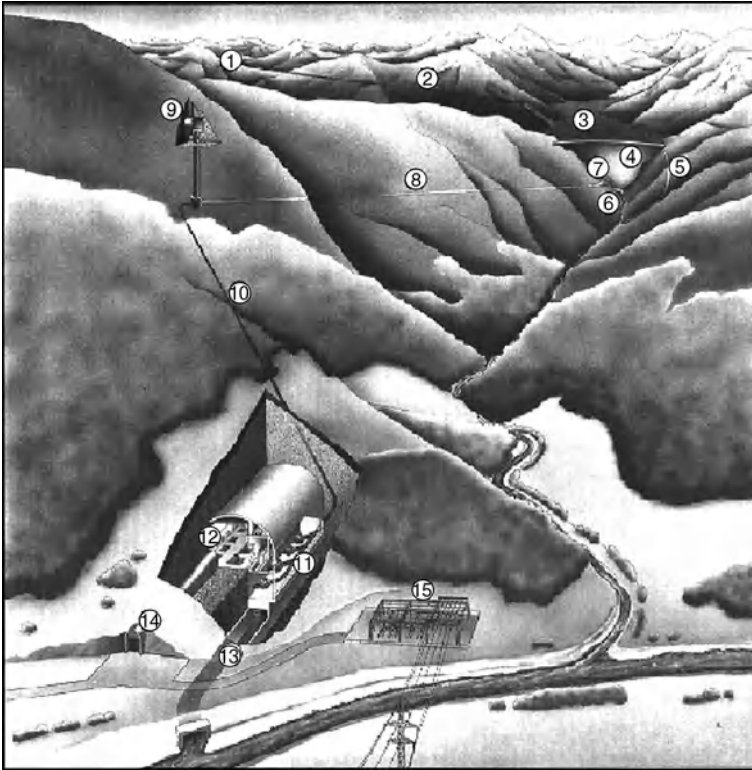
a Hauptelemente eines Jahresspeicherkraftwerks: 1 Wasserfassungen, 2 Zuleitungsstollen, 3 Stausee, 4 Staumauer, 5 Überlauf, 6 Grundablass, 7 Einlauf, 8 Druckstollen, 9 Wasserschloss, 10 Druckschacht (oder Druckleitung), 11 Schieberkammer, 12 Maschinenkaverne (oder Zentrale), 13 Unterwasserstollen, 14 Zufahrtsstollen, 15 Schalt- und evtl. Transformierungsstation nach [4.11]
